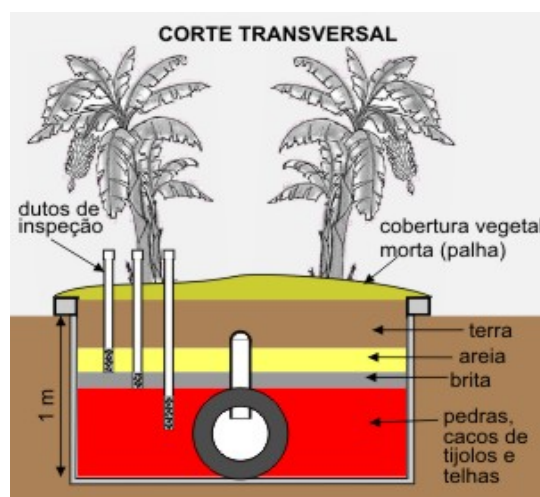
Esquema de Construção do Tanque de Evapotranspiração (Corte Transversal)
